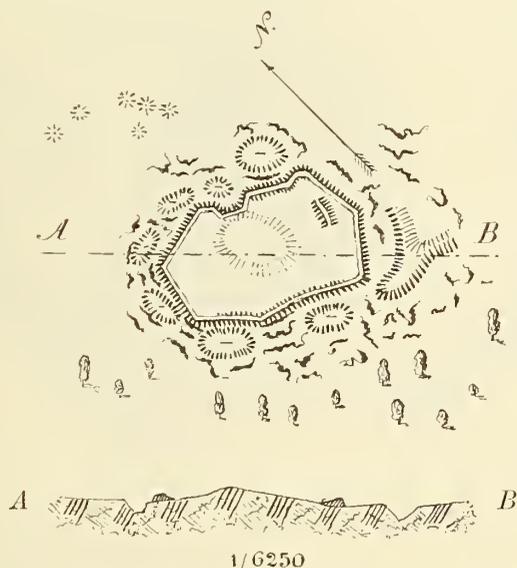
und 15. Grundriss und Durchschnitt des Wallbaues Podić bei Gorijevac.
